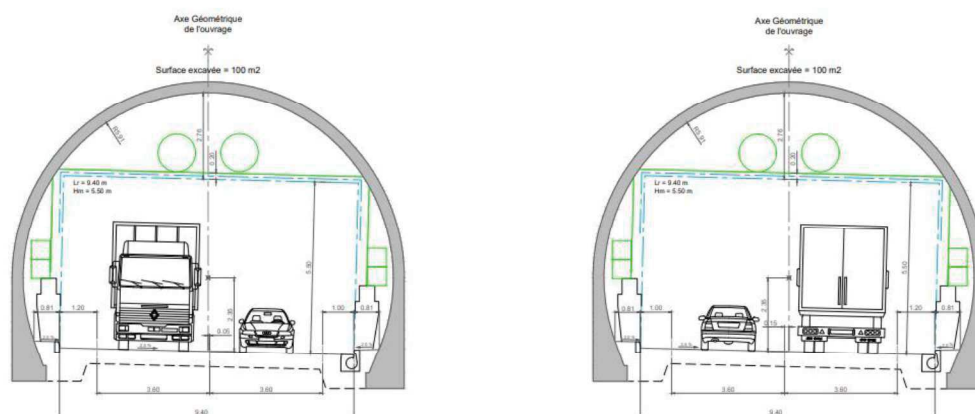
Sección transversal – Túnel (ancho útil: 9,40m)
